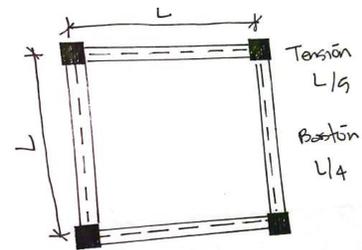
Premisas tecnológicas/constructivas- Losa tradicional de concreto
